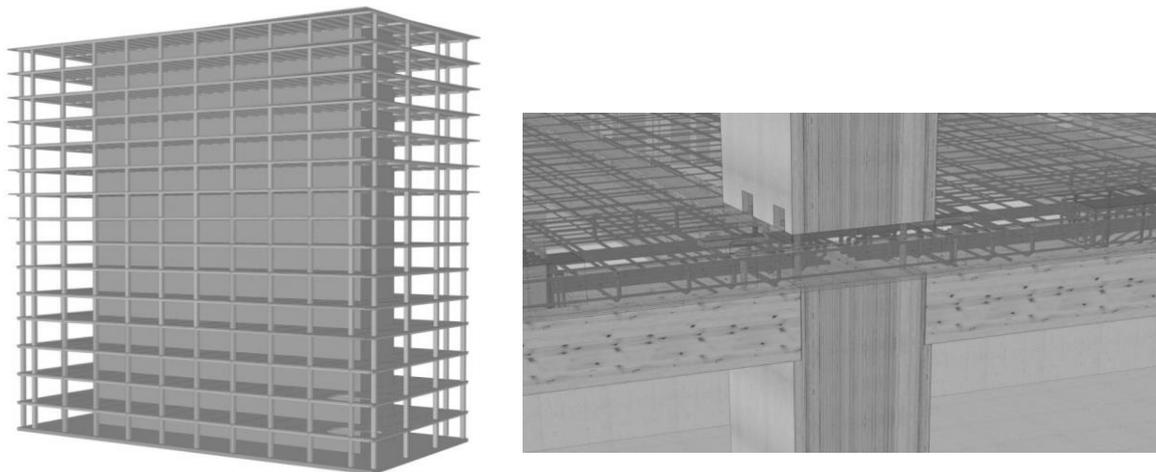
Rohbaumodell (links) und detaillierte Holzbauplanung (rechts)
